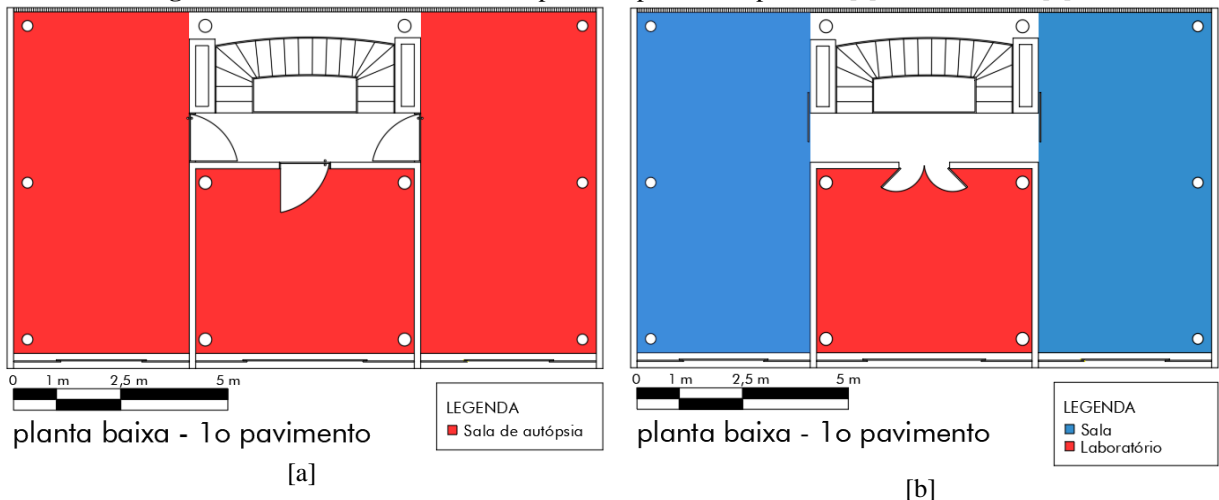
Planta baixa e zoneamento supostamente originais do pavimento térreo
